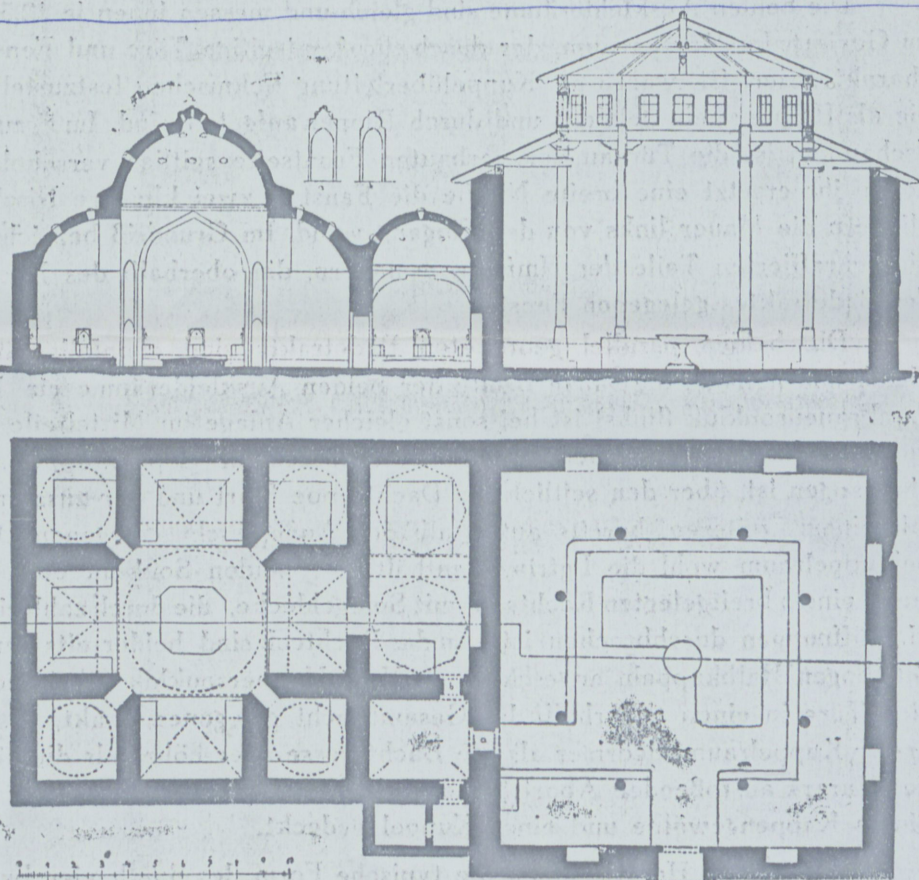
Agha Hamam, Grundriß und Schnitt.
